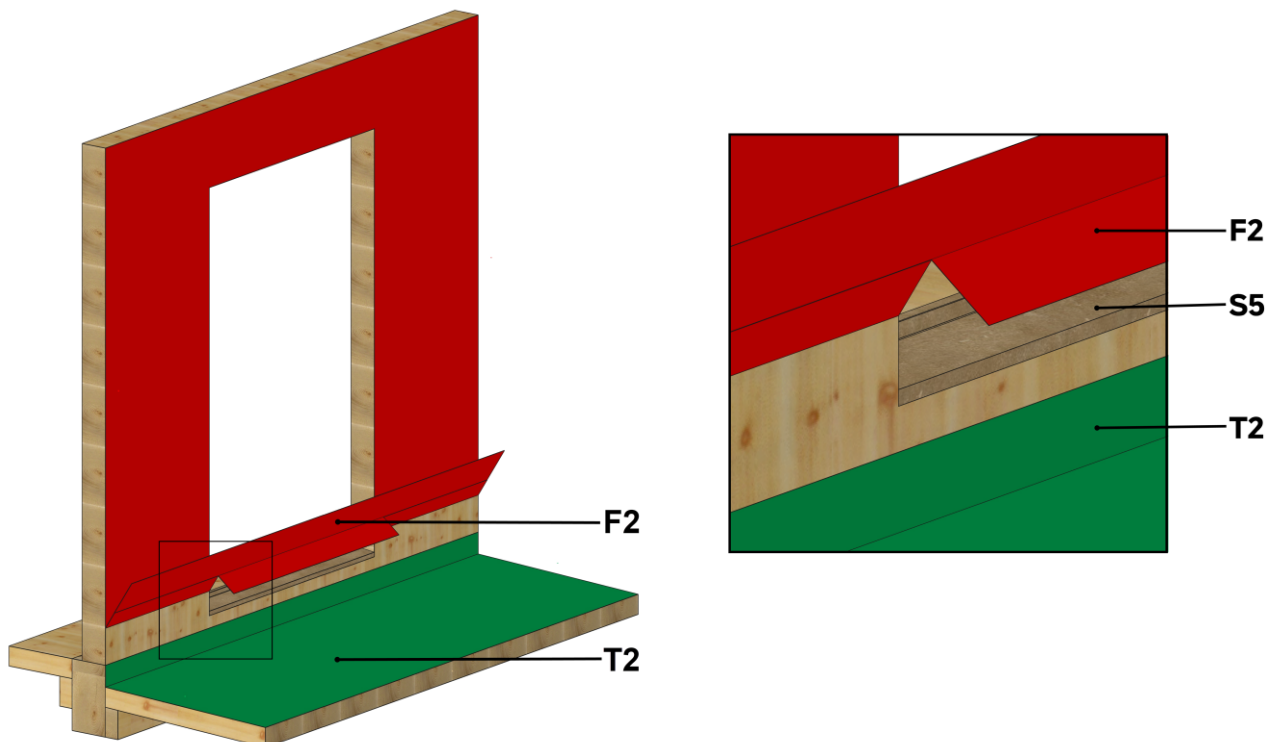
Exemple de traitement d'un relevé en configuration de toiture-terrasse accessible aux piétons et au séjour – Protection par dalles sur plots – Coupe sous appui de porte-fenêtre.
